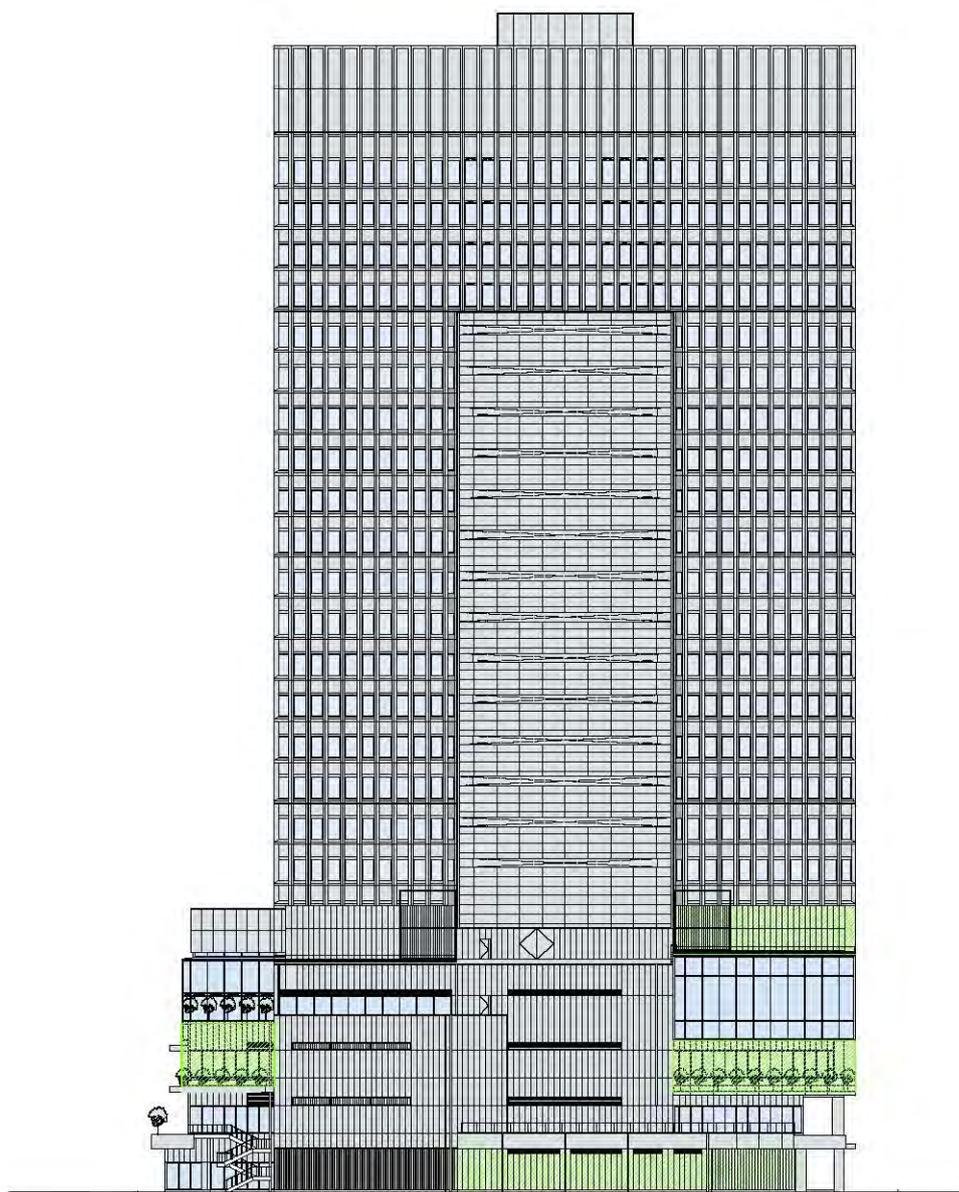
(2) 立面图 (東立面图 S=1:800)
